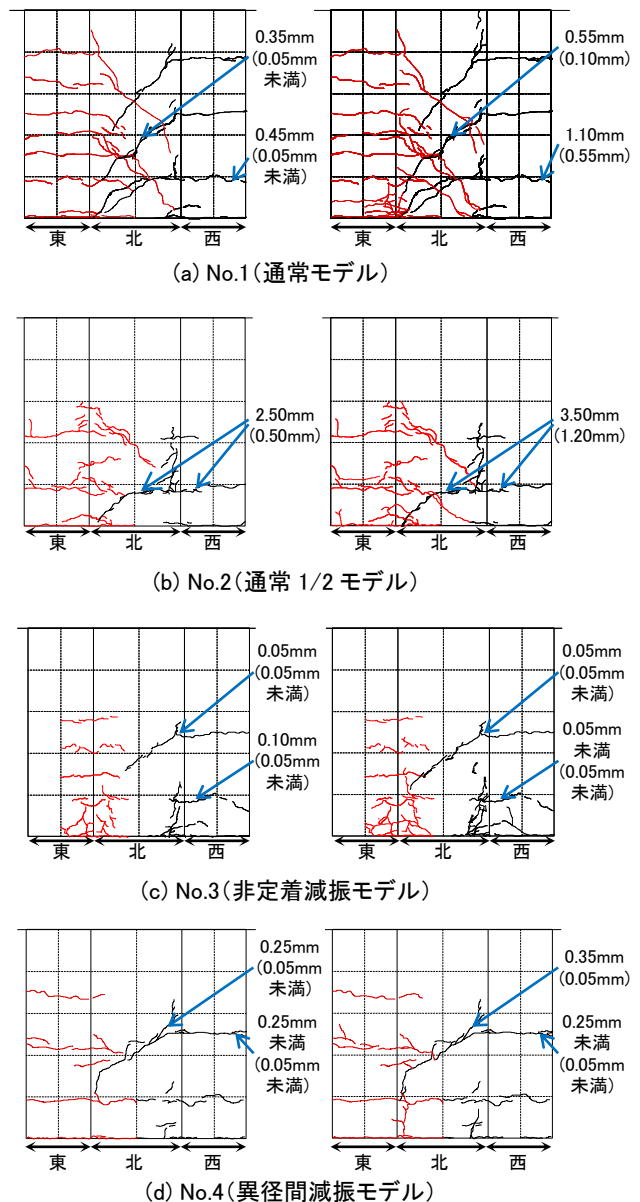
梁下端部のひび割れ状況(括弧内は残留幅を示す)
